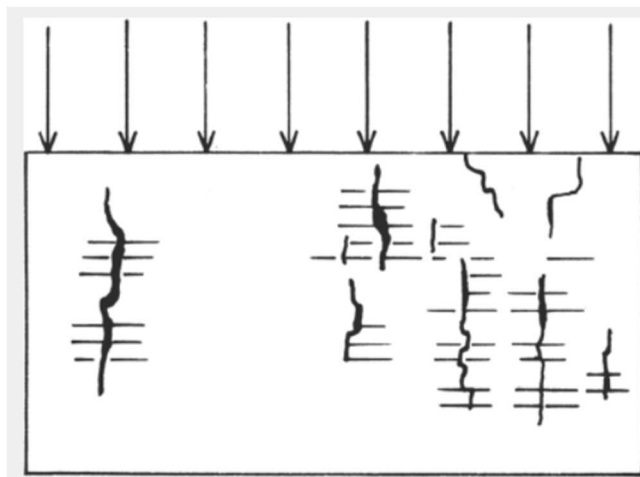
Fissura apresentada na argamassa de assentamento e blocos.
